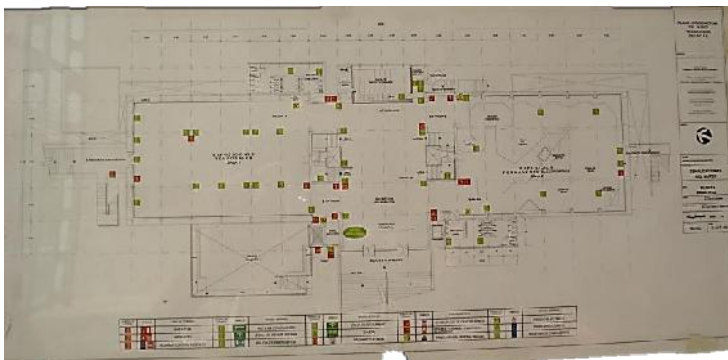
Plano arquitectónico de la planta baja MUTEK
